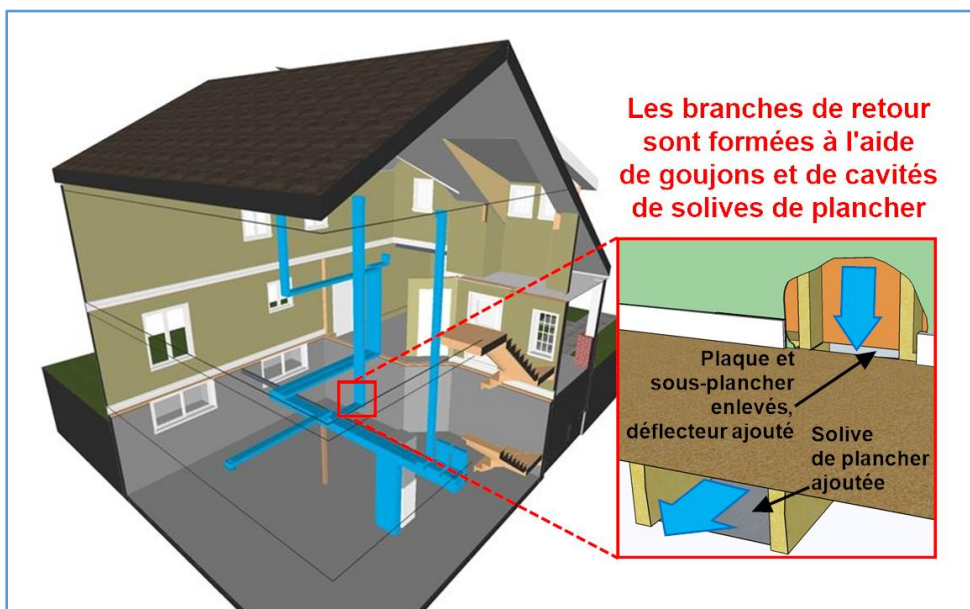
Exemple d'un système traditionnel de conduit de retour dans une maison à un étage
